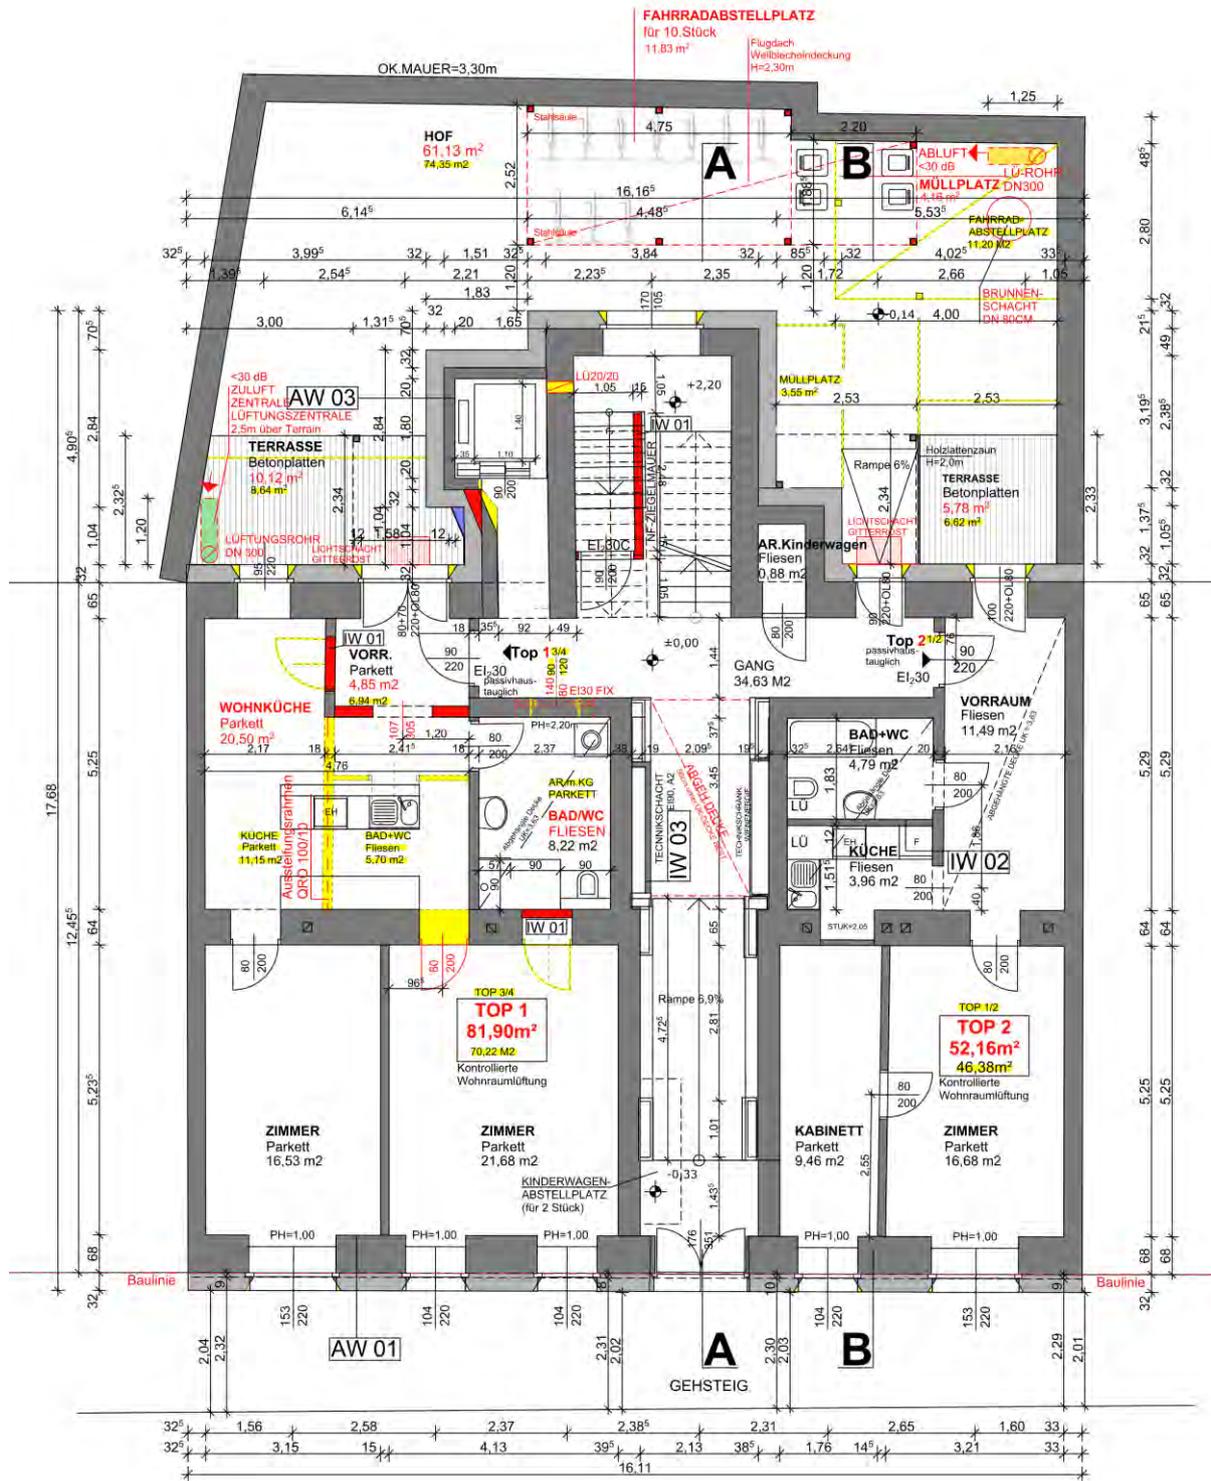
Grundriss Erdgeschoss [Quelle: Ageres Baumanagement]
